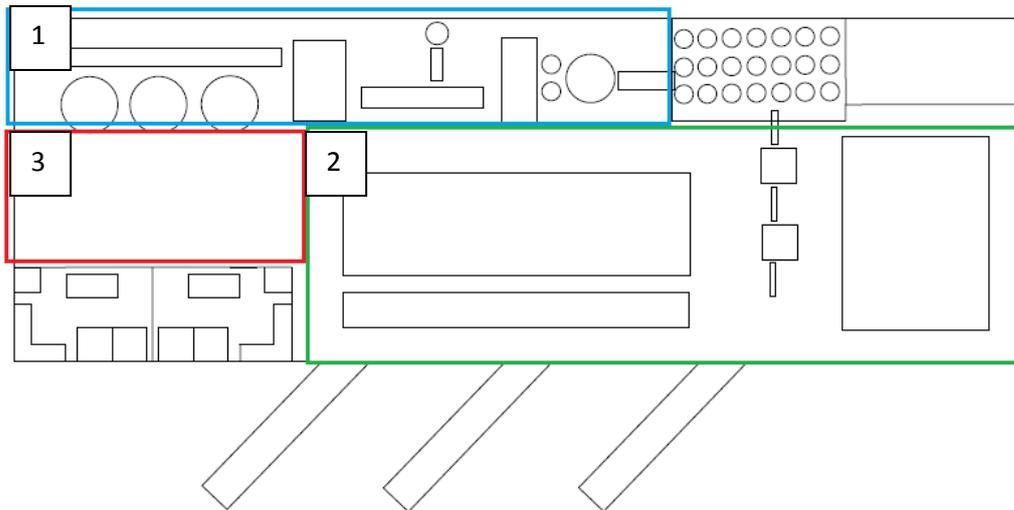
Zonas de la planta a estudiar para las propuestas de iluminación natural.
